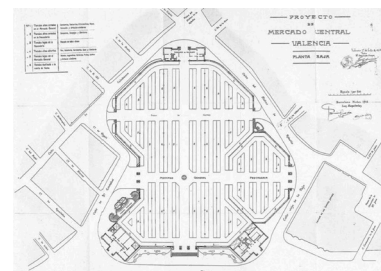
Planta del proyecto de Guardia Vidal y Soler i March con la Avenida del Oeste todavía sin ejecutar.
